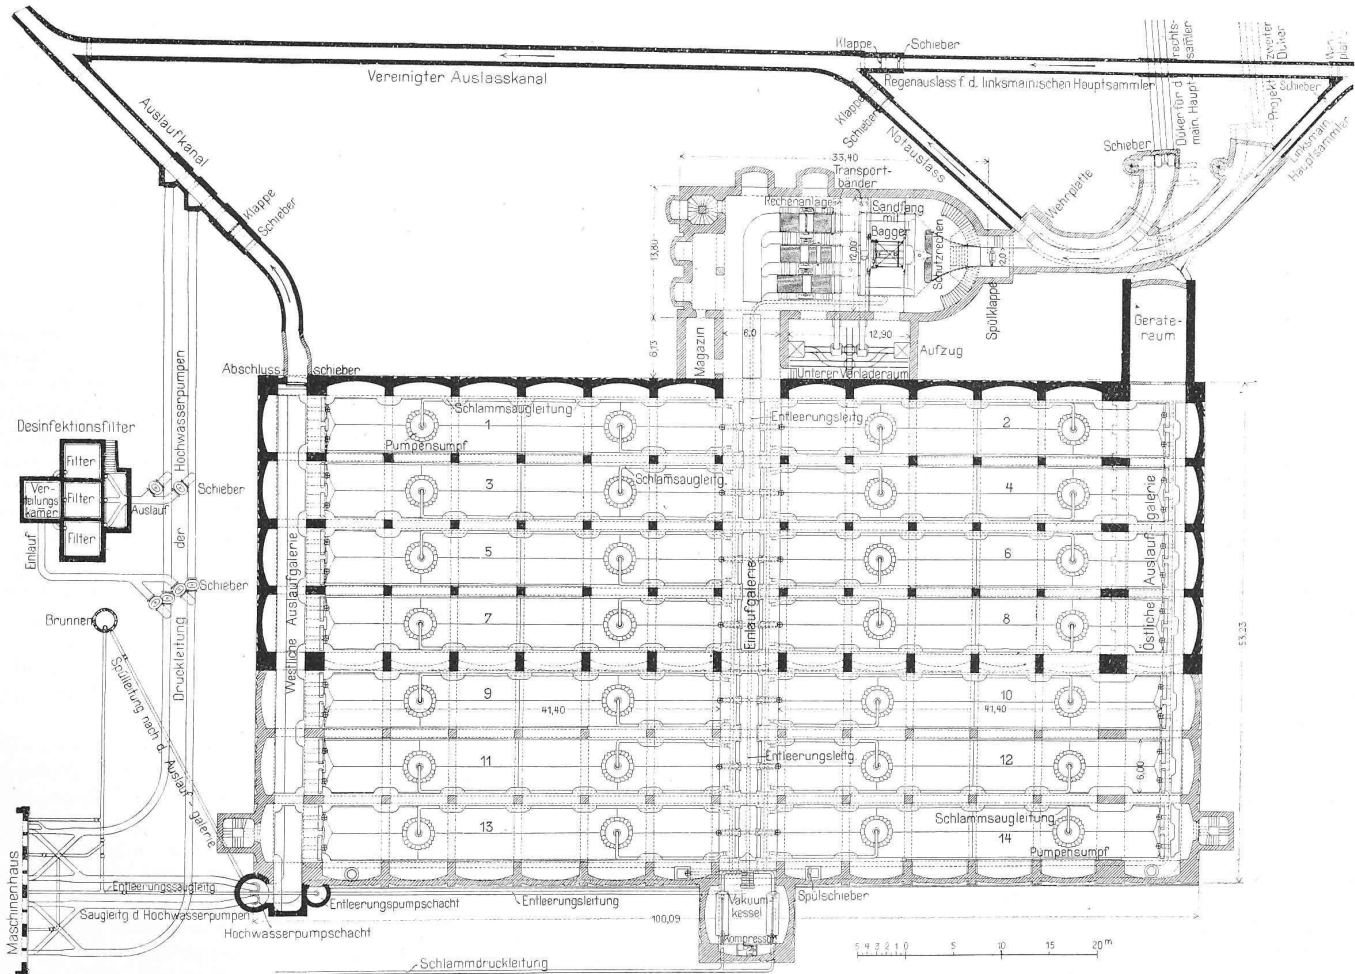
Grundriss der Kläranlage nach dem Umbau und der Erweiterung. — Masstab 1:700.
